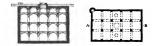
u. 263. Långenschnitt und Grundriss einer dreistockigen Cisterne in Alexandria.
